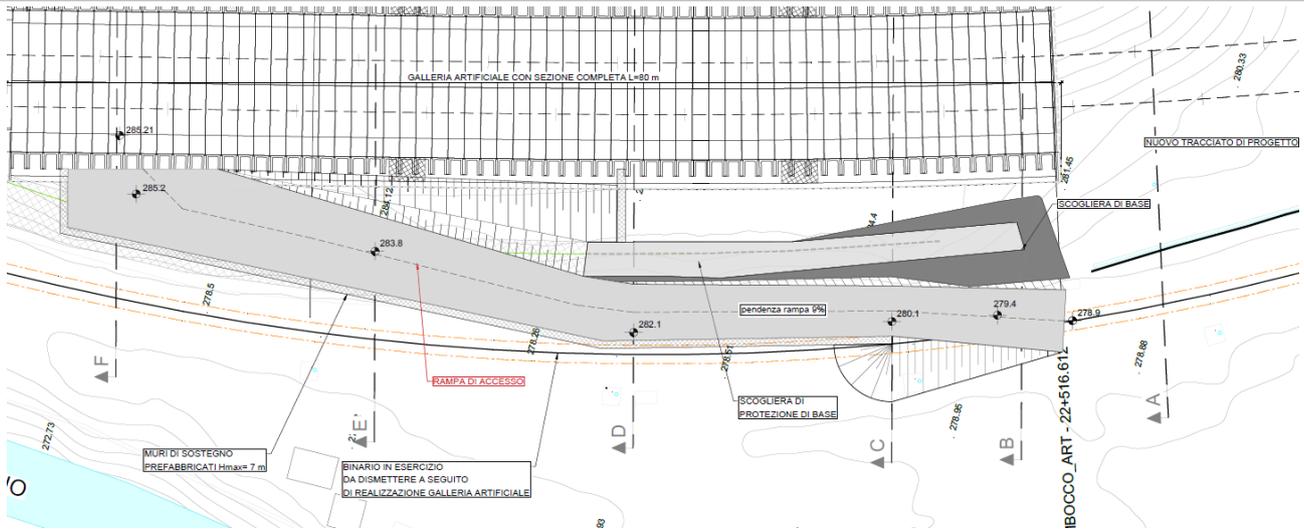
Stralcio della planimetria di progetto della rampa di accesso.
